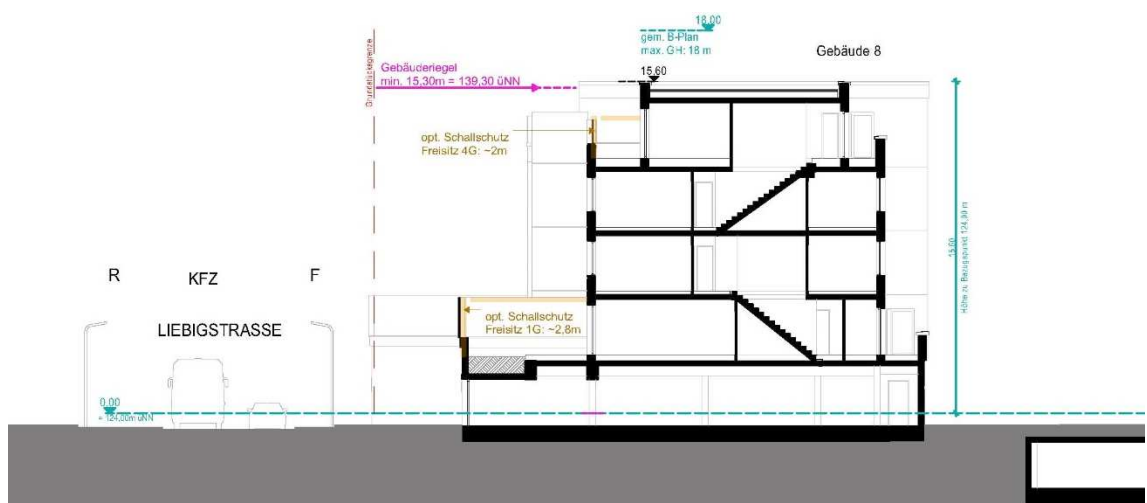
Schnitt West-Ost, Bereich Gebäude 8 mit Schallschutz Außenwohnbereiche auf Garagengeschoß und Dachterrasse, Stand Oktober 2019
